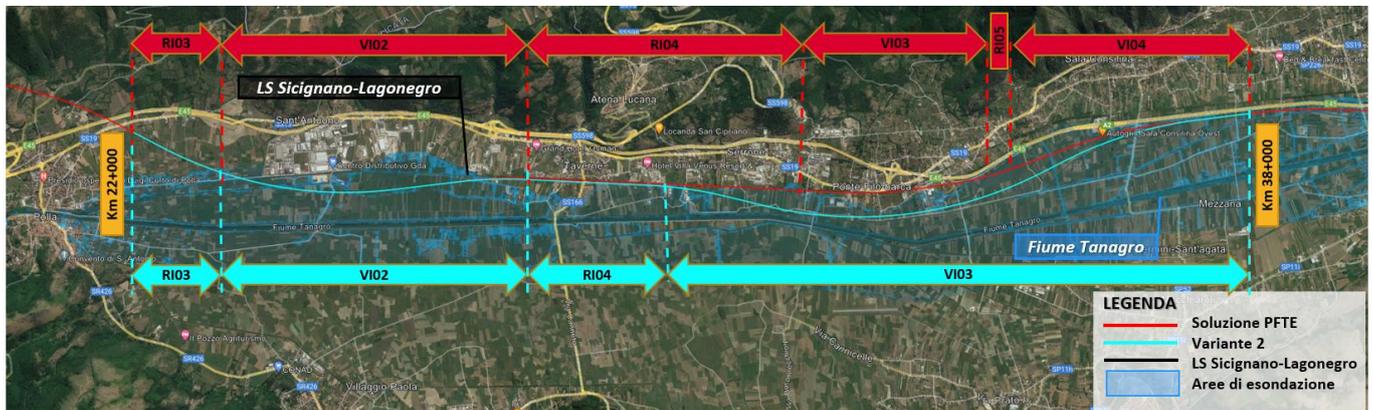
Stralcio planimetrico con confronto soluzione PFTE e variante 2
